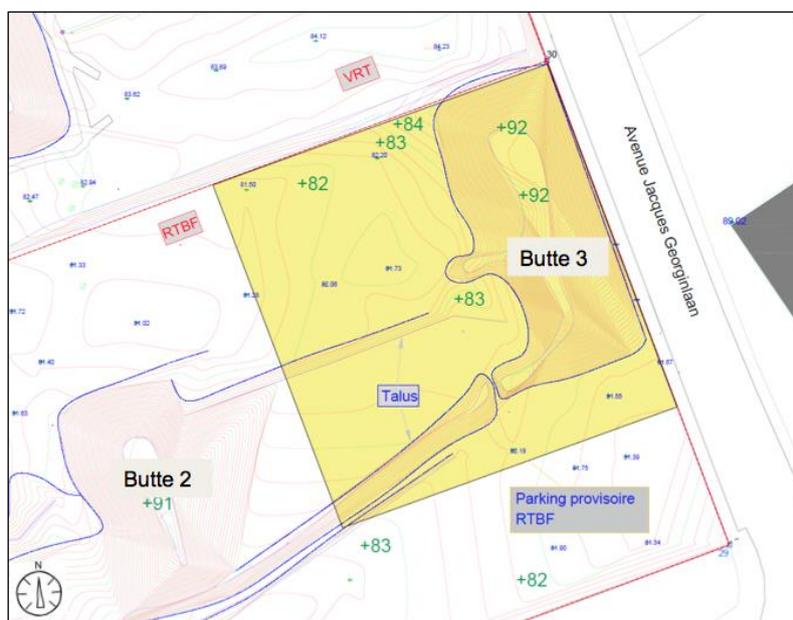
Localisation du parking provisoire sur le plan topographique
